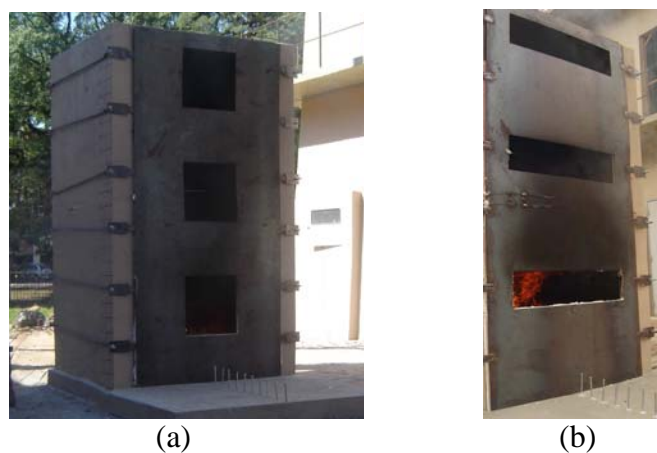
Configurações de fachada sem projeção horizontal e aberturas estreita (a) e larga (b).
